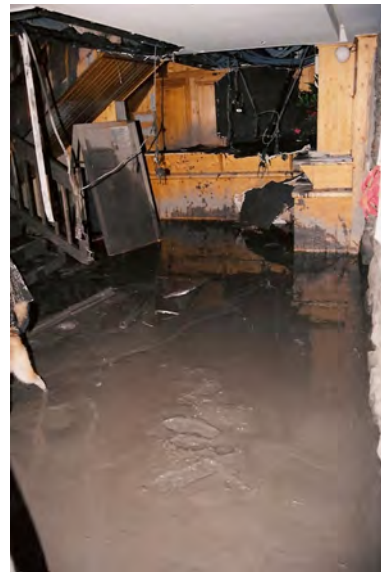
, 4.22, 4.23 : Envahissement d'une construction
